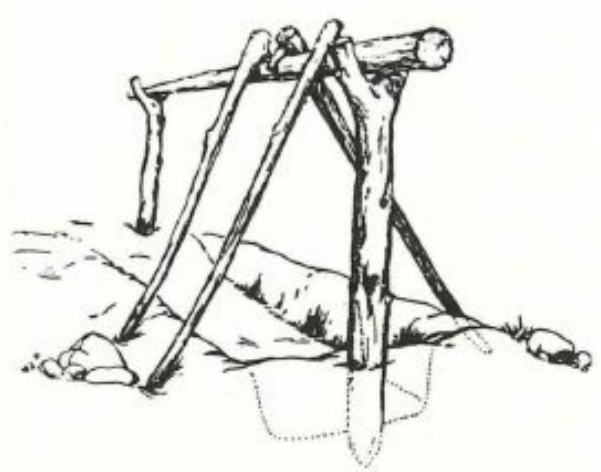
| Urtümliches Rofendachwerk eines Dachhauses
